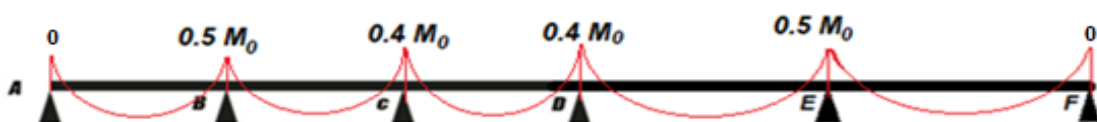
Schéma du 4^{ème} type de poutrelle.
